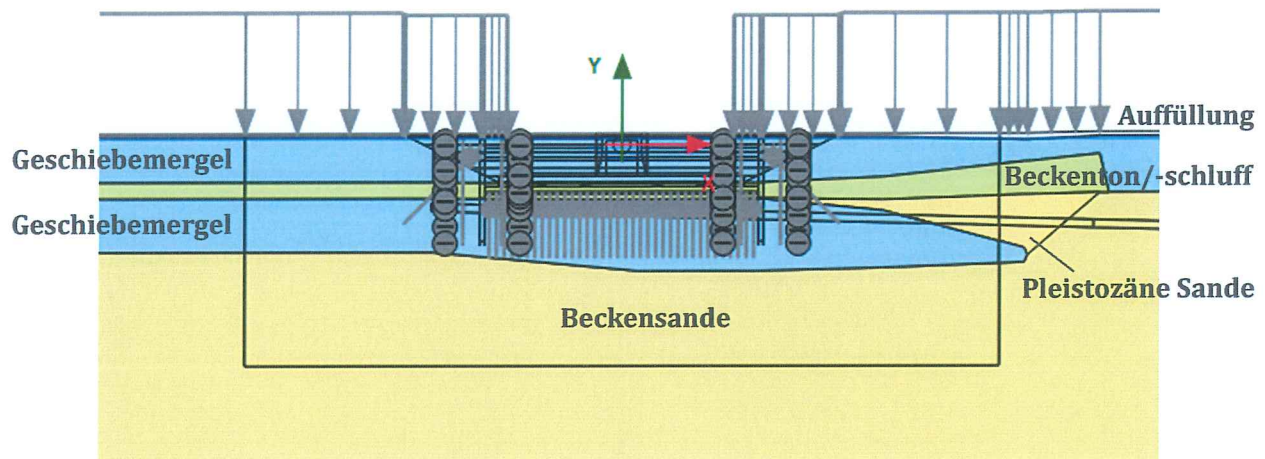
2D-Modell und Baugrundaufbau im Ausschnitt
